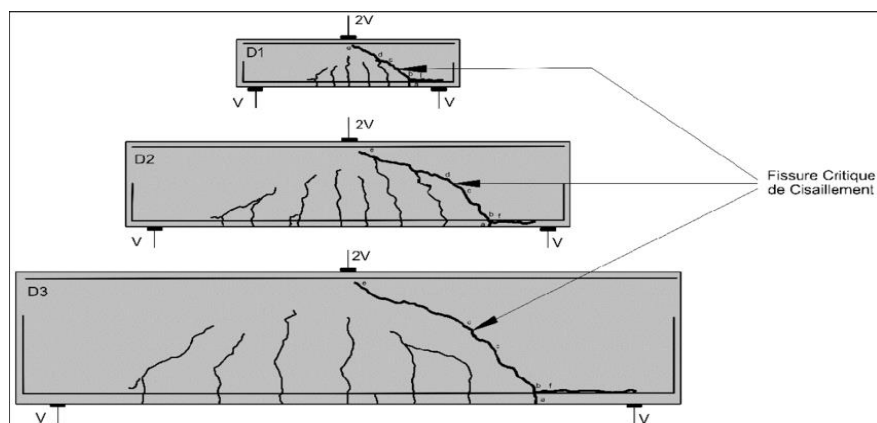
Profils de fissurations pour les trois poutres [58].
